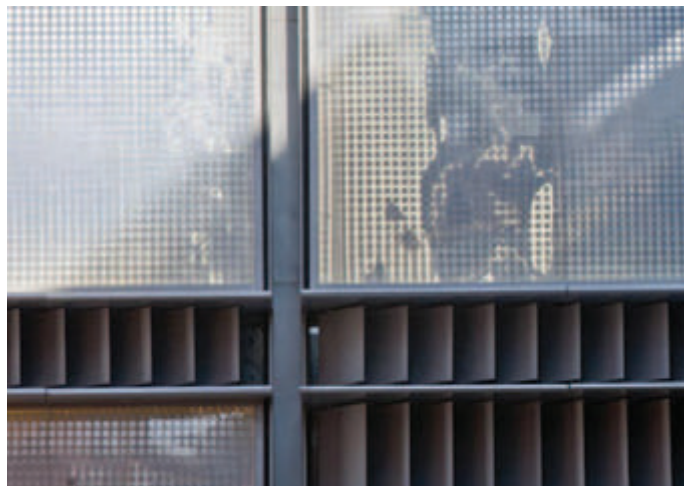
Etisalat building -brise-soleils et panneaux ETFE gonflables. Crédit: NF&A
